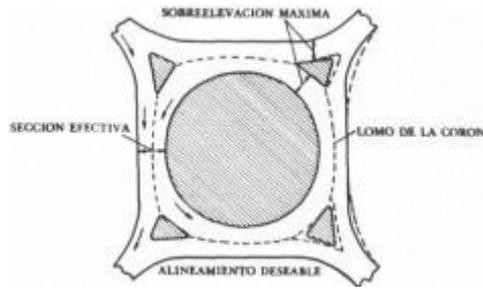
Intersección rotatoria simétrica de planta cuadrada
